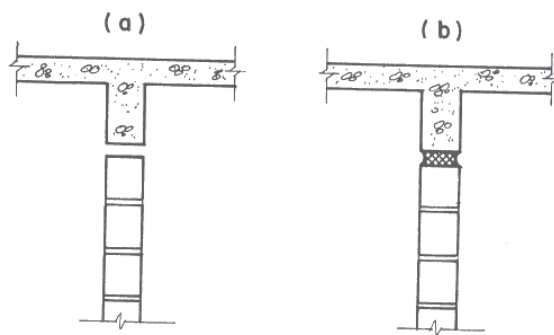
Desvinculação entre a parede fissurada e o componente estrutural. (a) corte no topo da parede; (b) preenchimento com material deformável.
